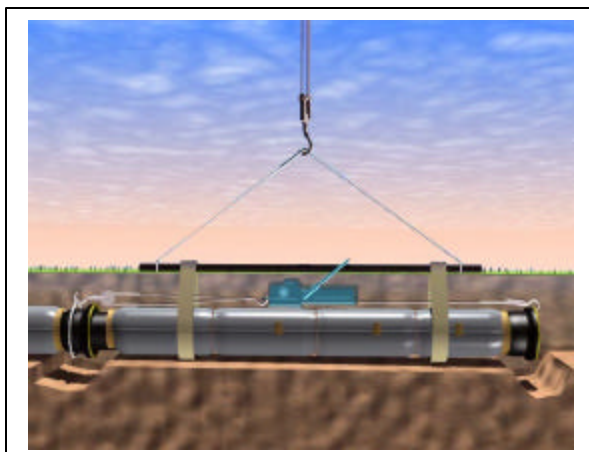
O tubo será colocado na vala e procedida a montagem, com equipamentos adequados, mantendo sempre a dobra na geratriz superior. Deverá ser tomado cuidado para que o cabo de aço (montagem com tirfor) não danifique a manta.
